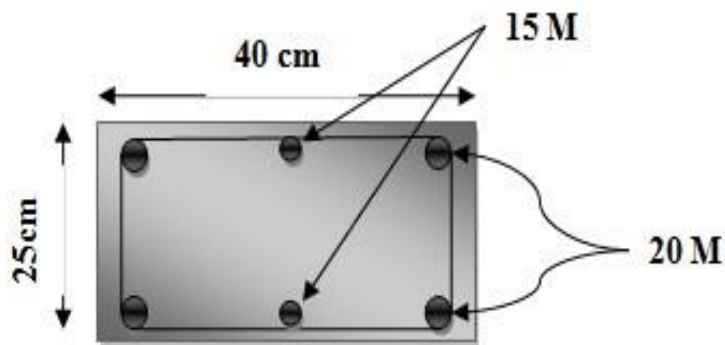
Ferrailage de la section du poteau en compression selon le code CSA
